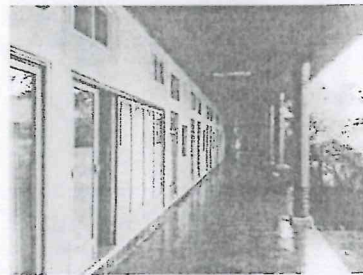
Pisos, muros exteriores y columnas en buen estado.
